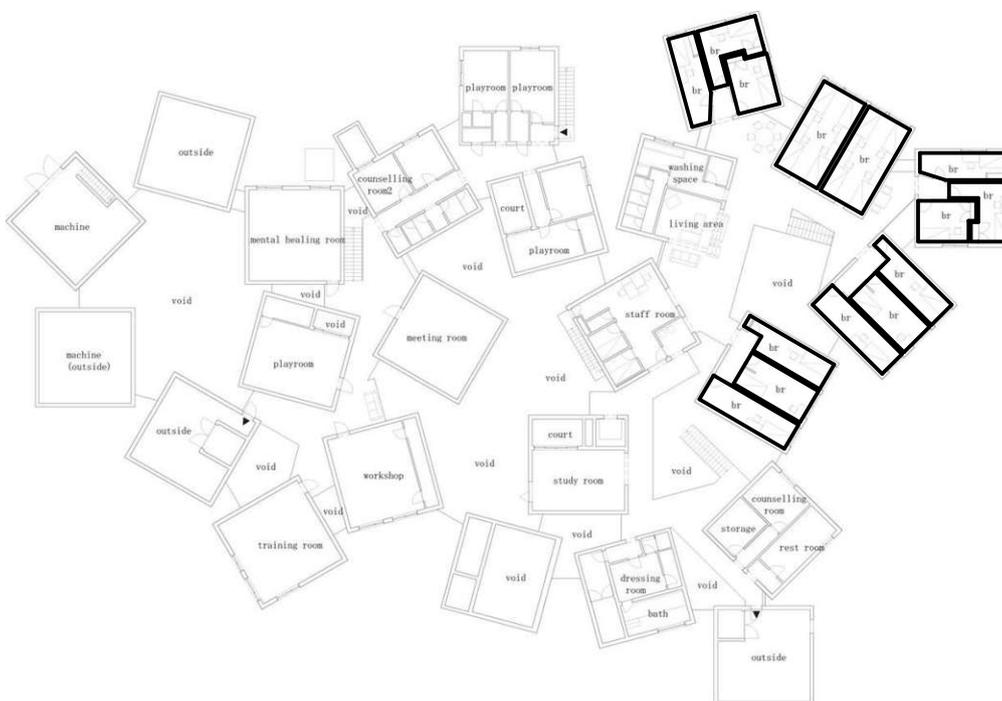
Grundriss Obergeschoss +1 M 1:500
